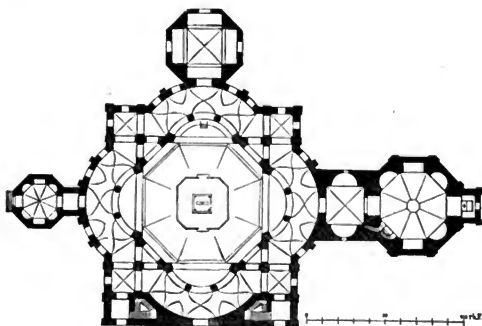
S. Lorenzo in Mailand. Grundriss.
